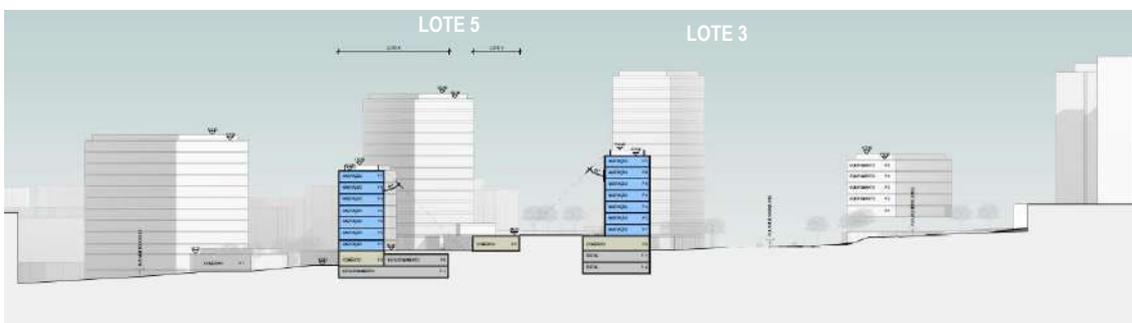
Perfis da proposta do Loteamento, lote 3 e 5.
